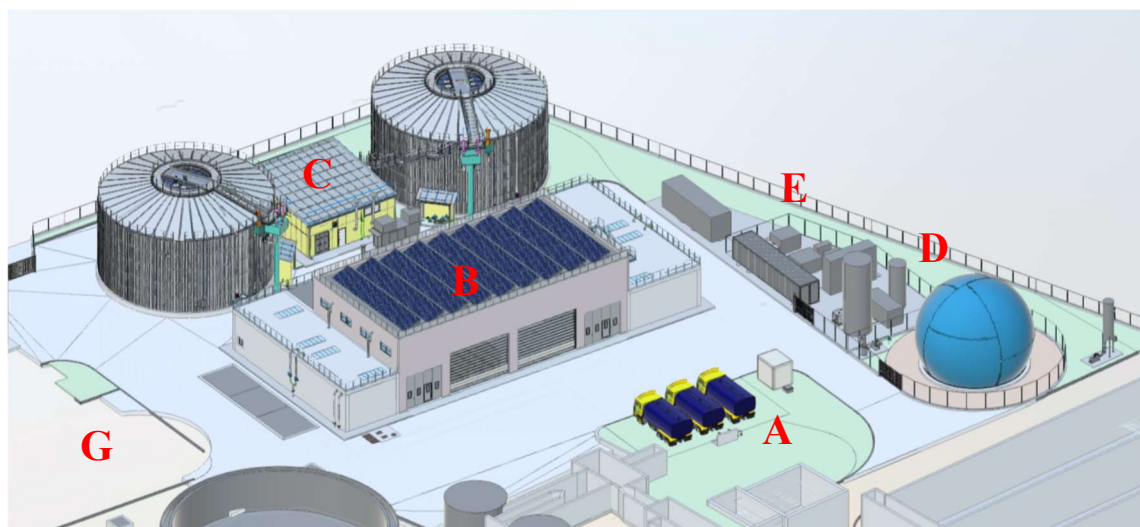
Opere di progetto - viste 3D configurazione di progetto (modello BIM) – lato sud-est
